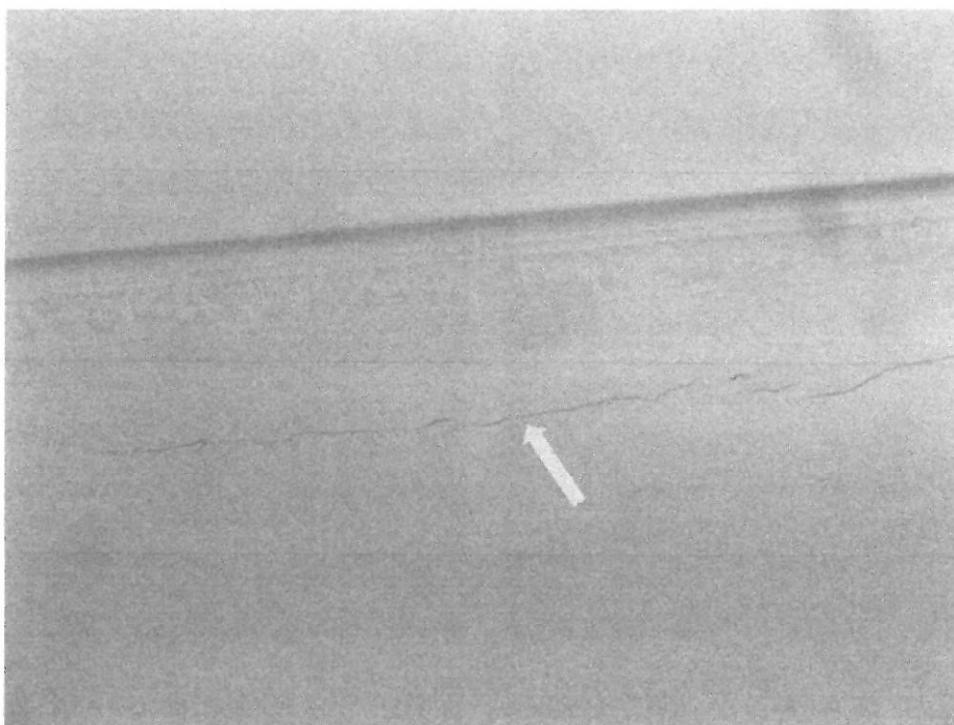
Przykładowe zarysowania na sklepieniach (26.08.2021)
